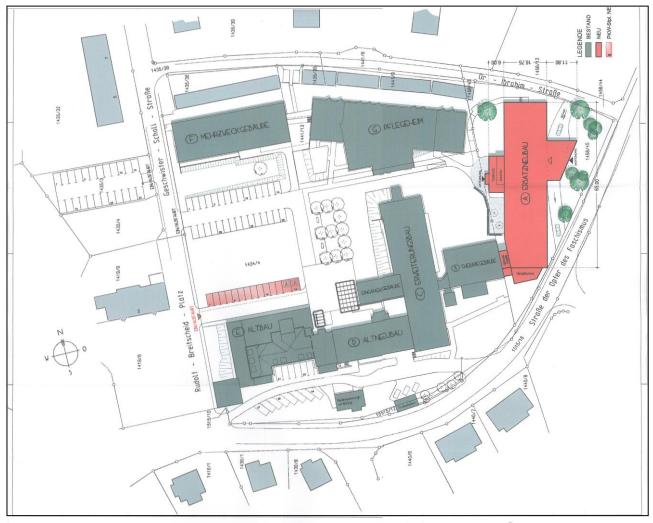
Lageplan der Gebäude (Quelle Seiffert Architekten und Ingenieure, Bauantrag Kreiskrankenhaus Ersatzneubau)
